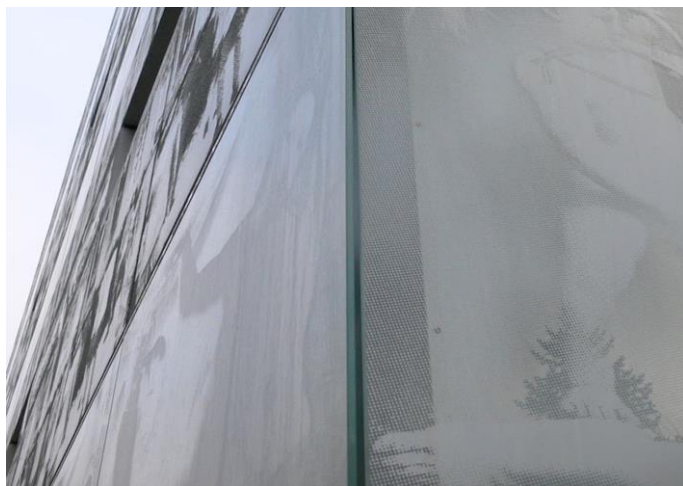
Detalhe dos painéis de vidro na fachada da biblioteca (Janssen, 2013)
